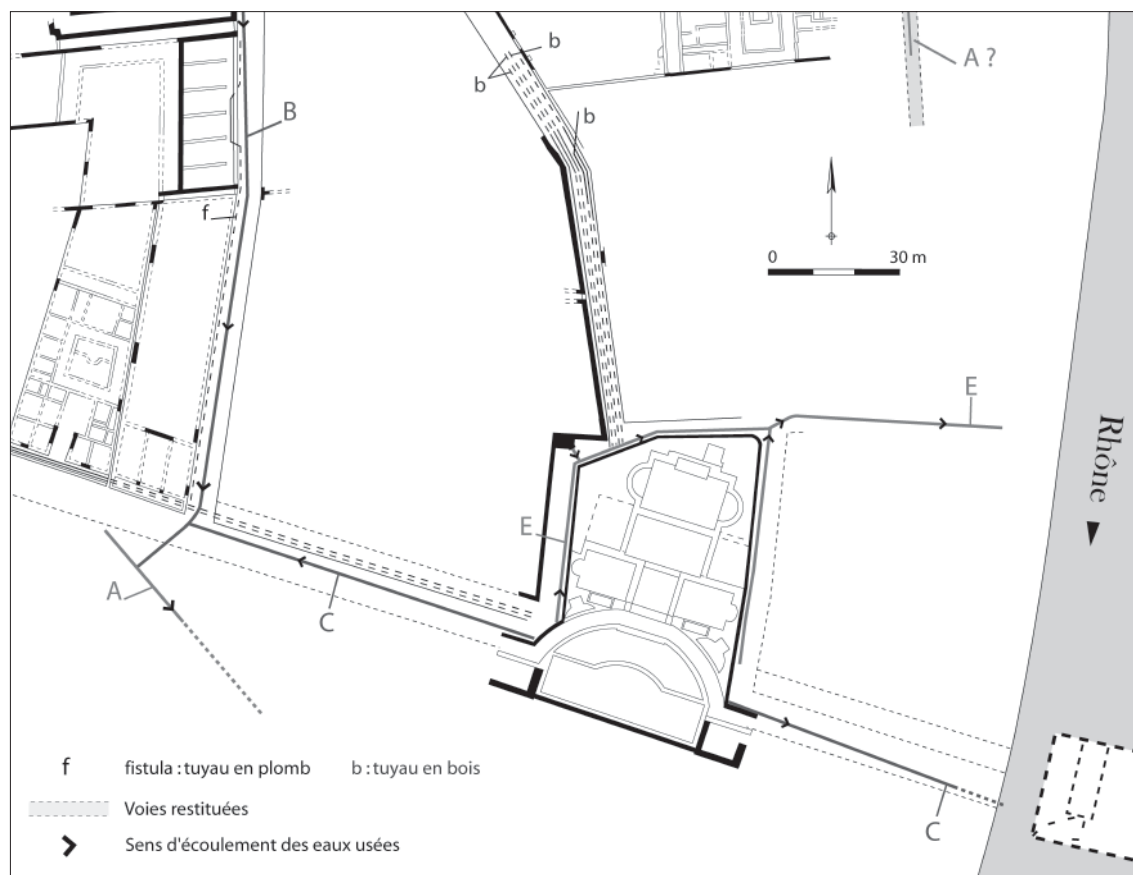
Plan du quartier et réseau des collecteurs après construction des thermes des Lutteurs. (L. Brissaud, J.-L. Prisset).
